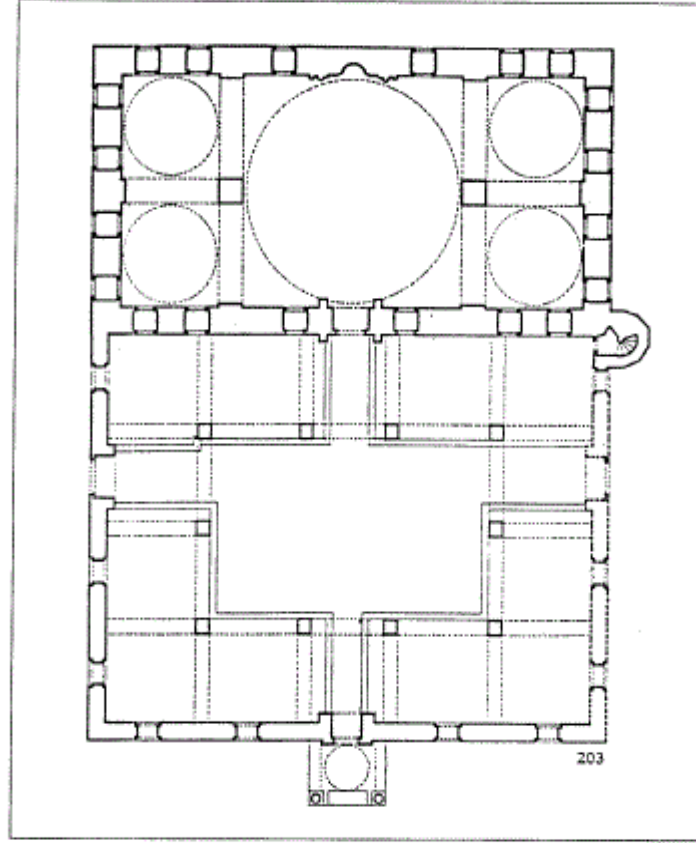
مسقط أفقي لمسجد الخان في طلاس (عن: Türkmen)
